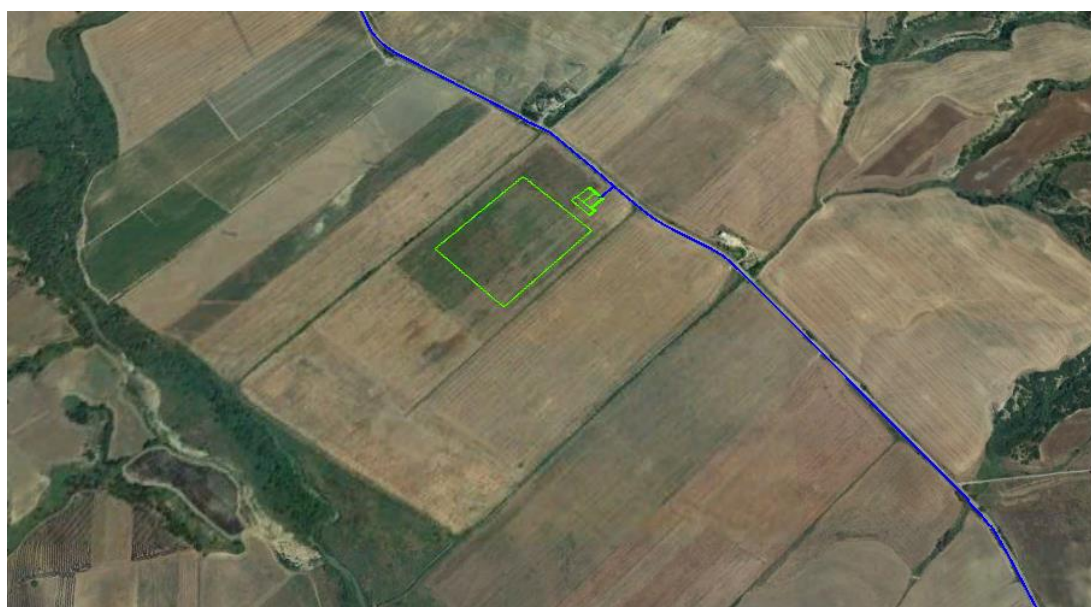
Ubicazione Stazione di rete e tracciato cavidotto
